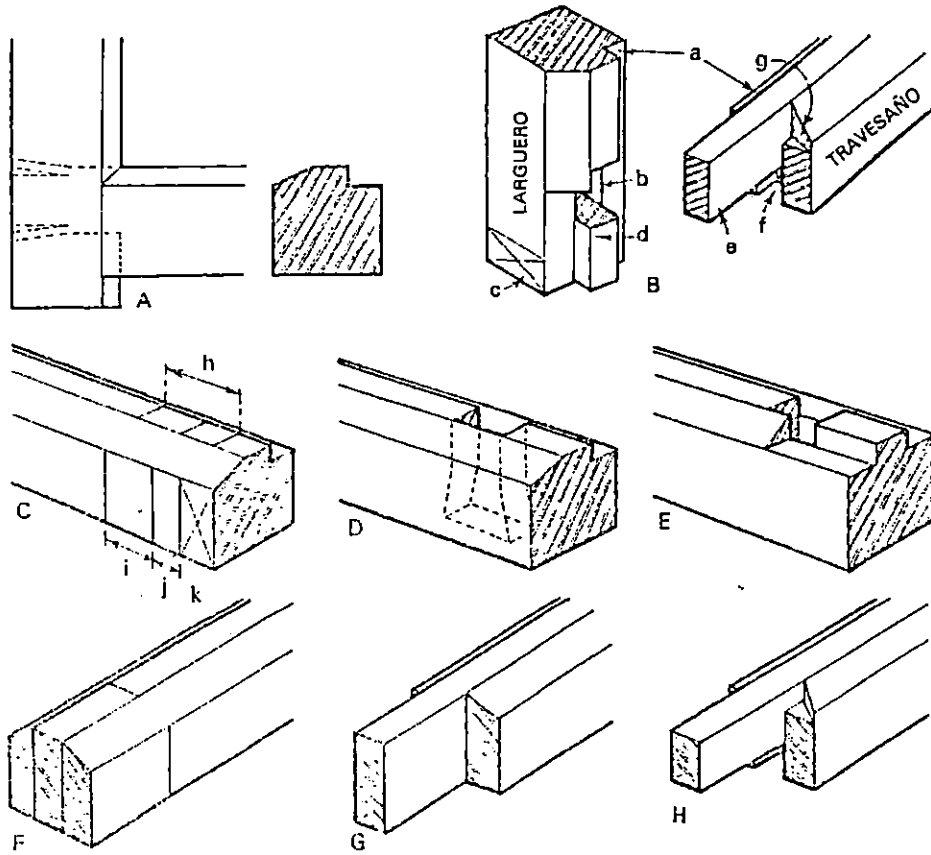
A ensamble de caja y espiga para una sección estándar rebajada y achillanada; B piezas separadas: a rebaje; b caja; c sobrante; d puntal; e espiga; f franqueo; g contraperfil; C marcas de la caja: h anchura total del travesaño; i longitud de la caja (anchura de la espiga); j franqueo; k sobrante;
